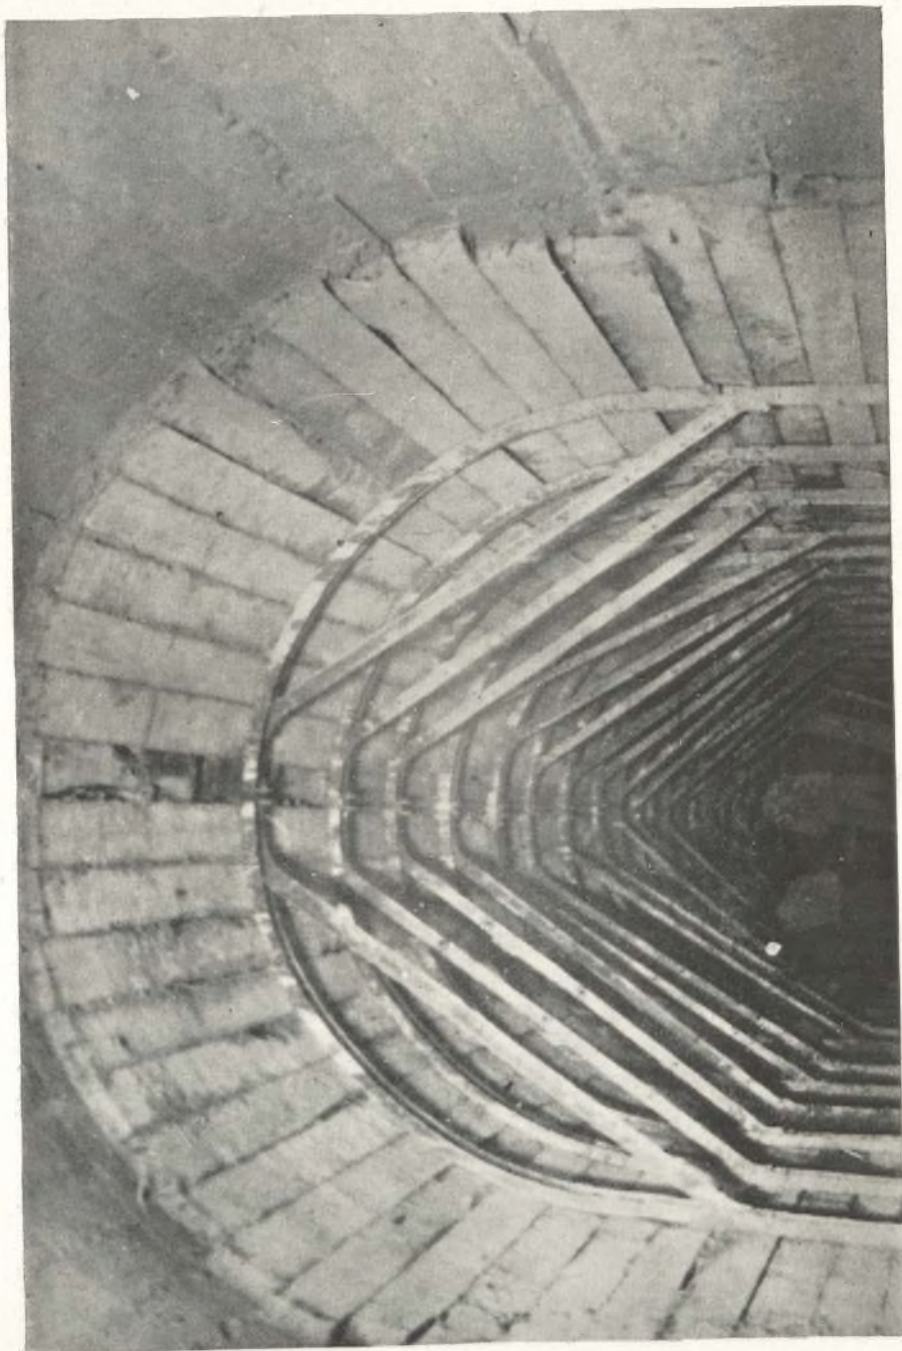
Galería de la calle de Bailén (primer trozo). Detalle del encofrado con cerchas metálicas.
